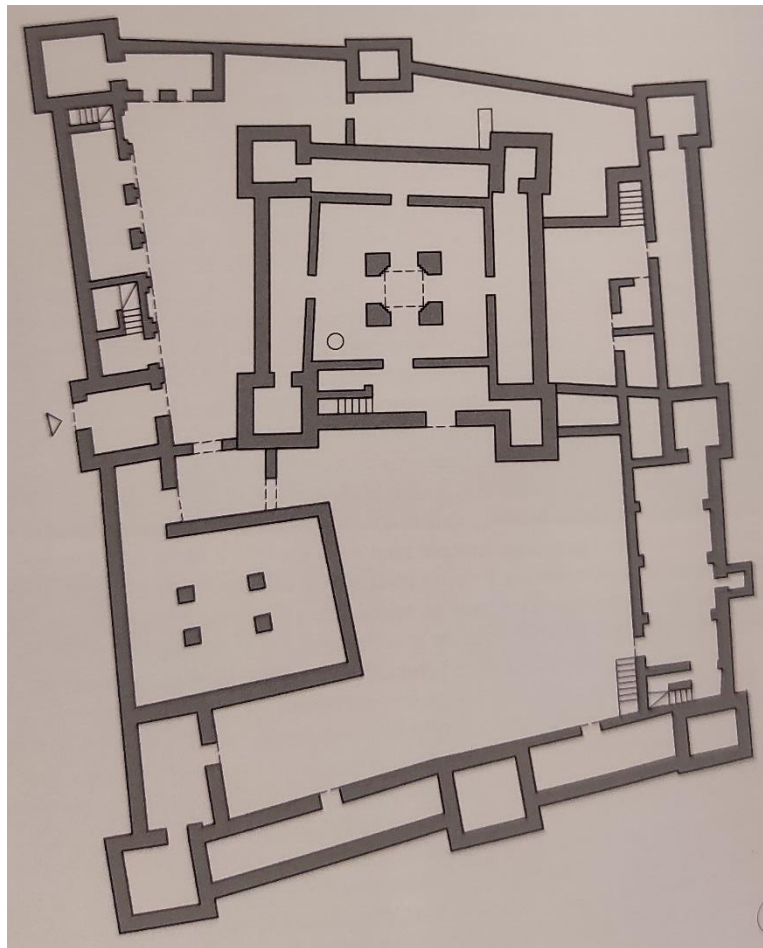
planta Kasbah Ait Said Ou Mansour-Marruecos.
